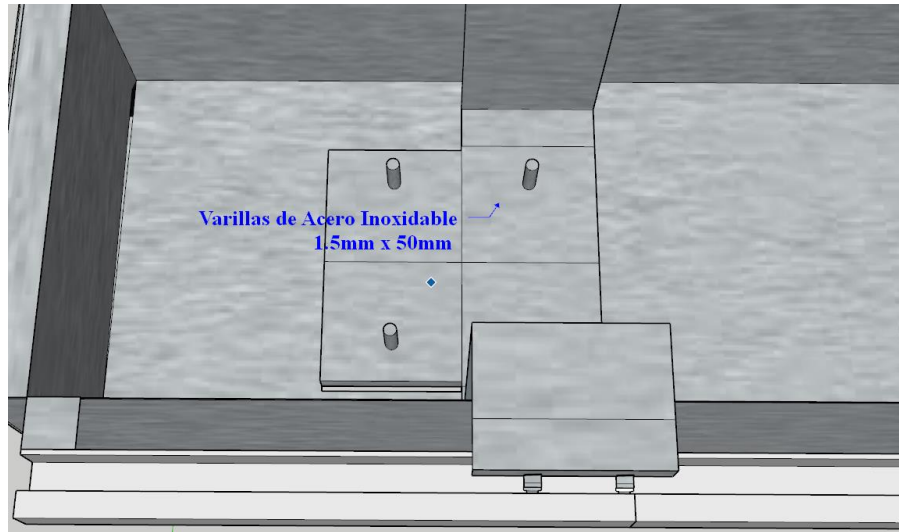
Diseño soporte en acero inoxidable soldadas, Fuente propia software utilizado (SketchUp Pro-2022)
